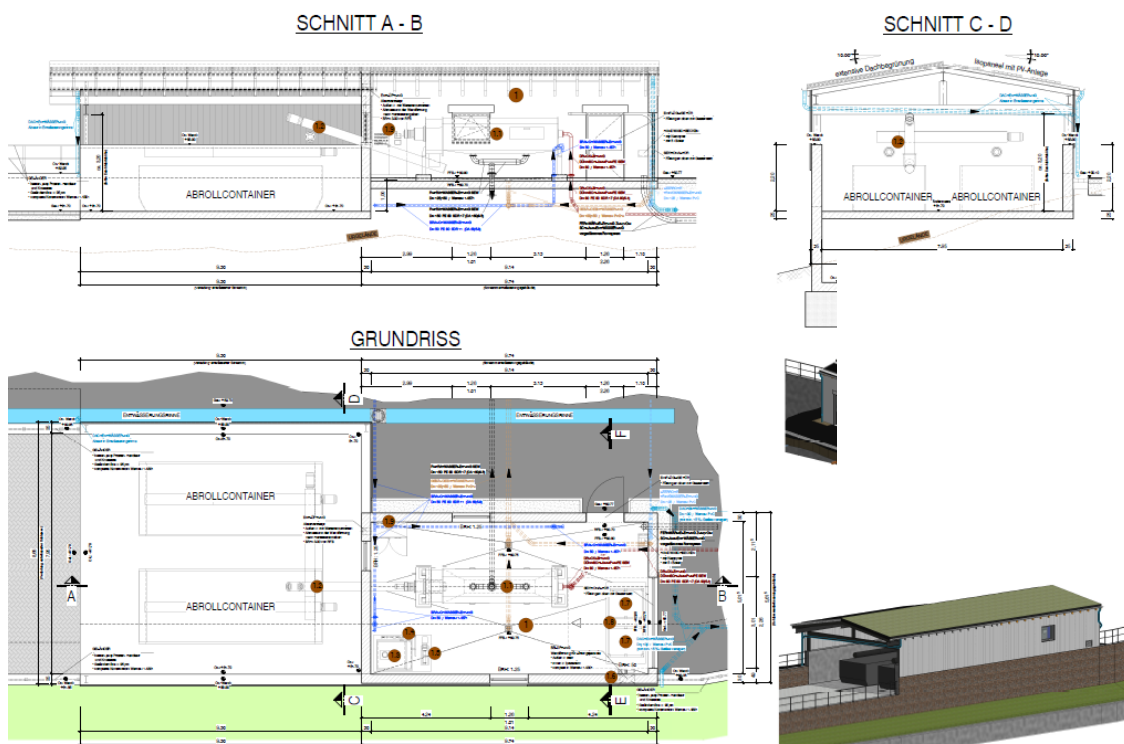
Schlammentwässerungsgebäude und Schlamm-lagerhalle
